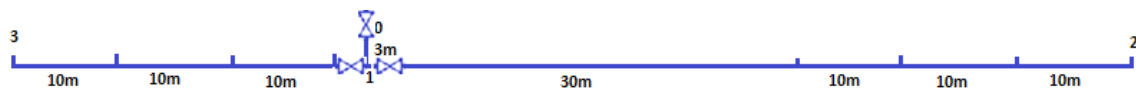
Croquis instalación AFS "Plazas segunda fila".
